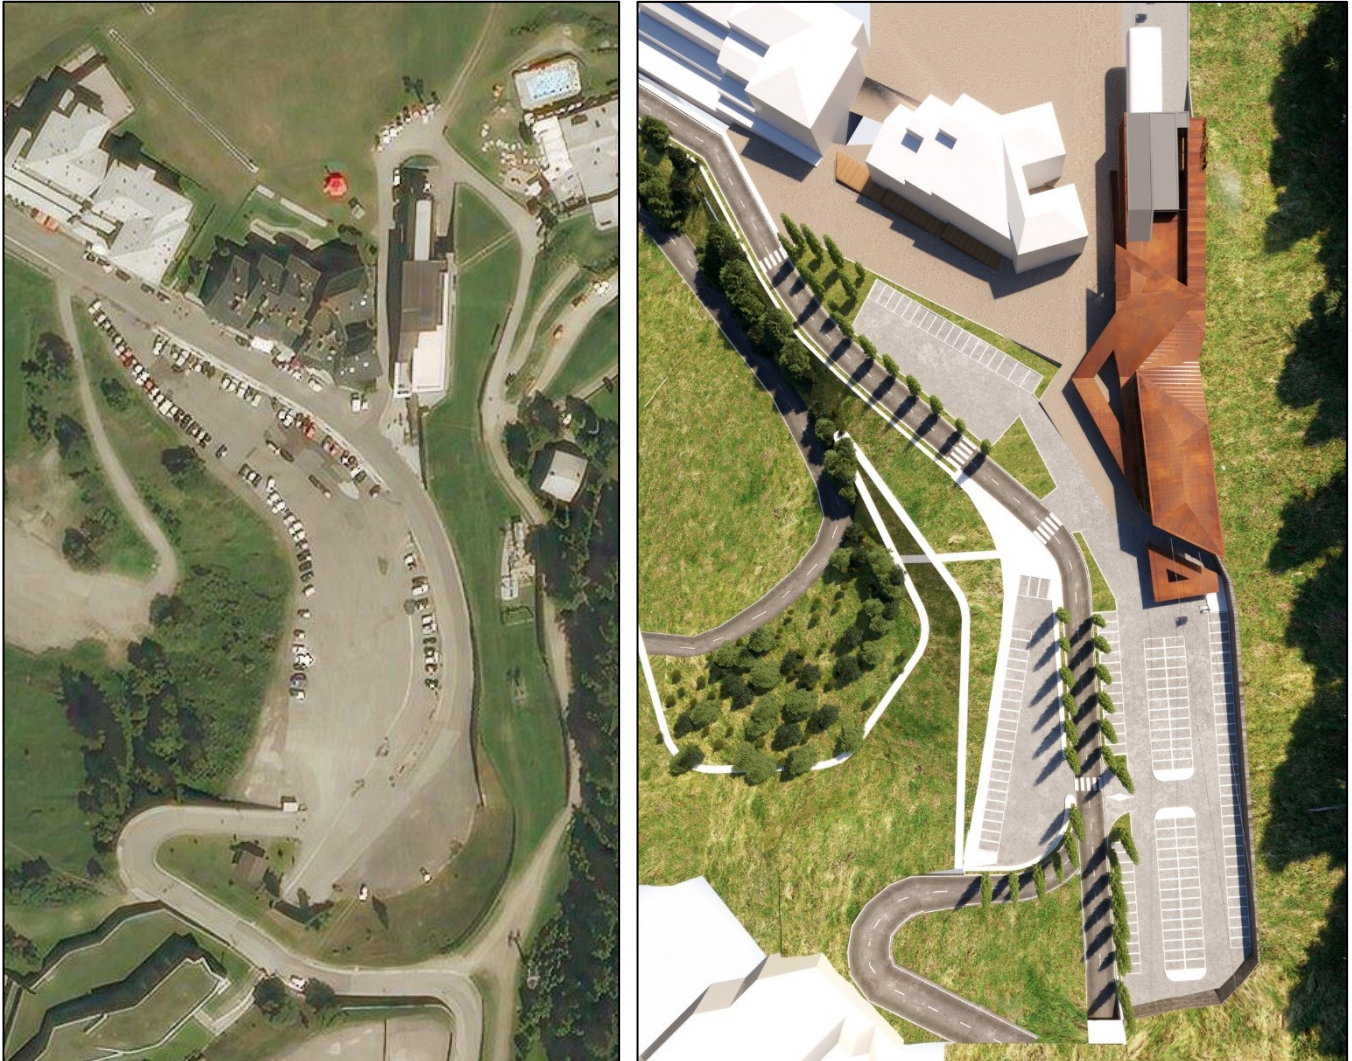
ASSETTO URBANISTICO E VIABILITÀ – STATO ATTUALE E RENDERE DI PROGETTO
